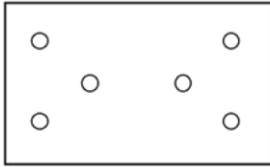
Panneaux de dimensions 1200 × 400 mm - plans de chevillage « en plein » (espacement entre chevilles ≥ 150 mm)
